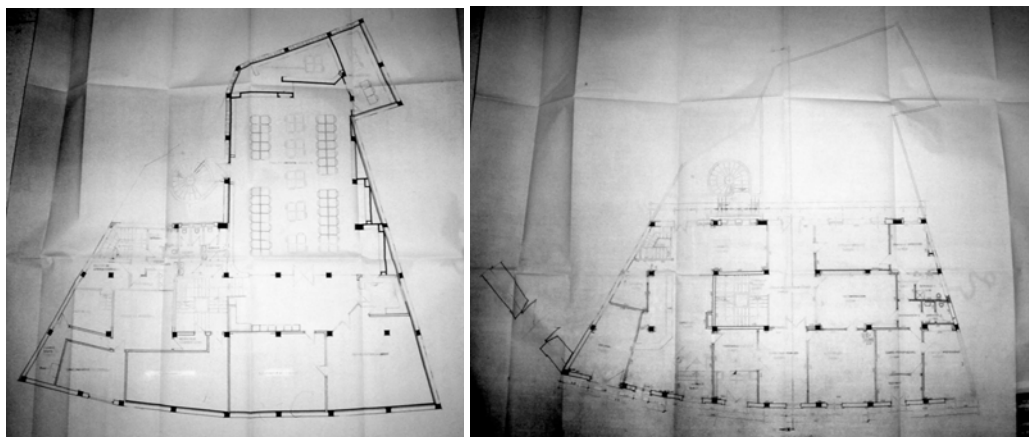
y 368. Colegio de España: sótano y planta baja, por A. Barbero y L. Gómez, 1987.
